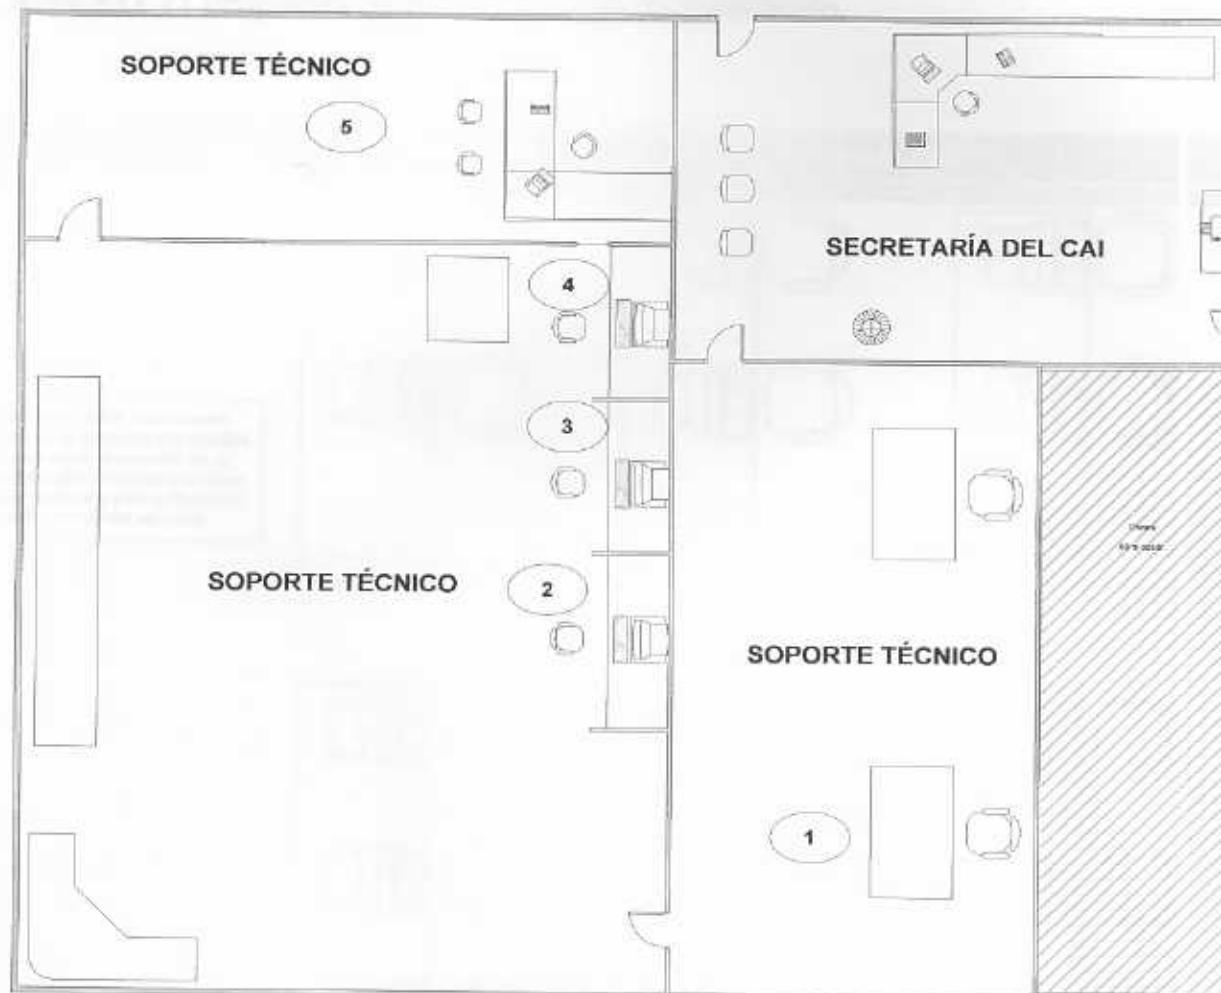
Vista de planta de los puestos de trabajo del soporte técnico y secretaría del CAI.
